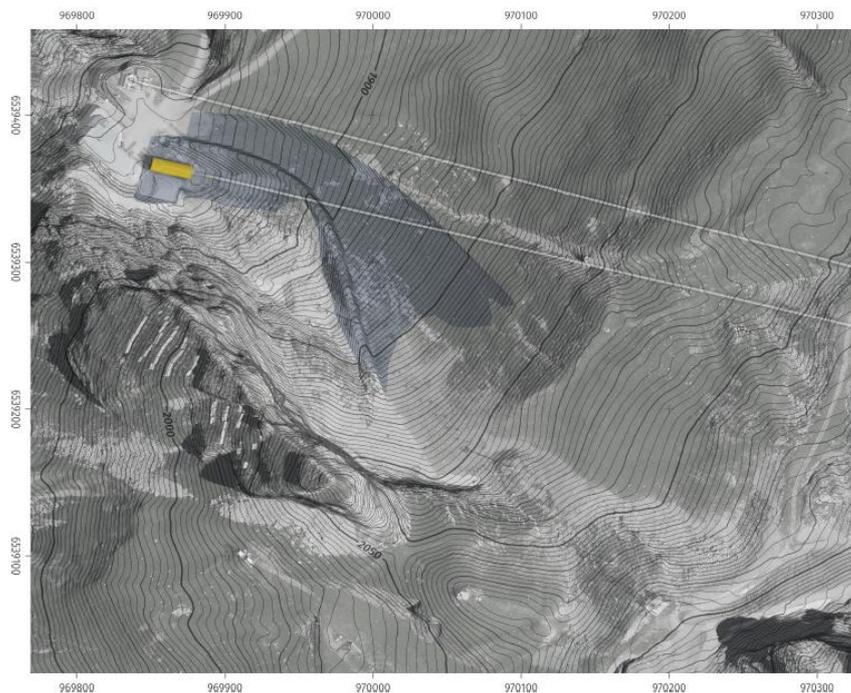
Vue en plan de l'ouvrage de protection. Échelle 1:3 000.
